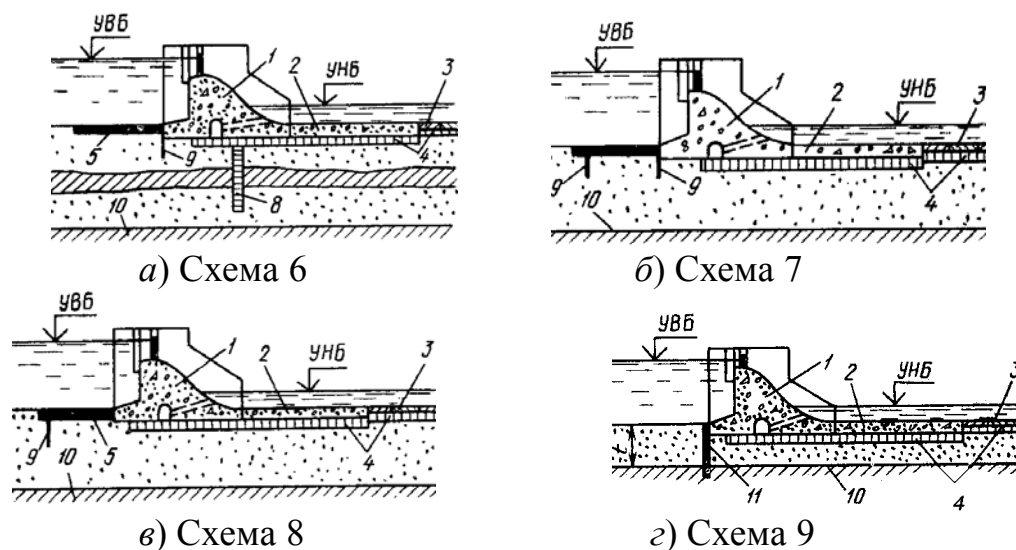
Схемы 6-9 подземного контура бетонных водосбросных плотин на нескальных основаниях:
